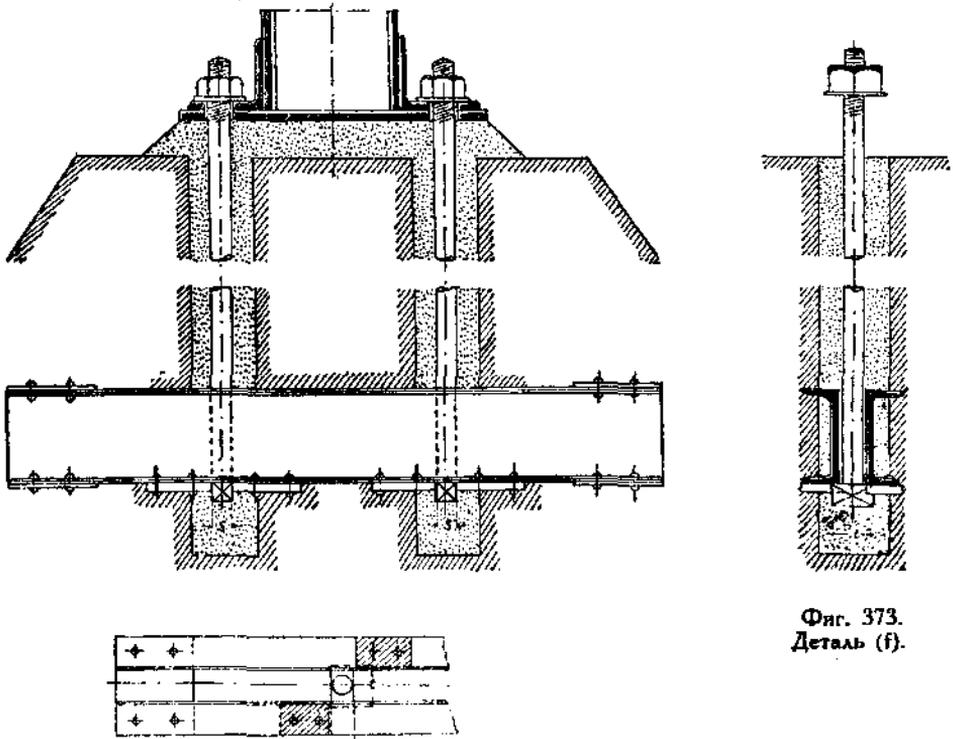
Заделка металлической стойки на каменном фундаменте.
